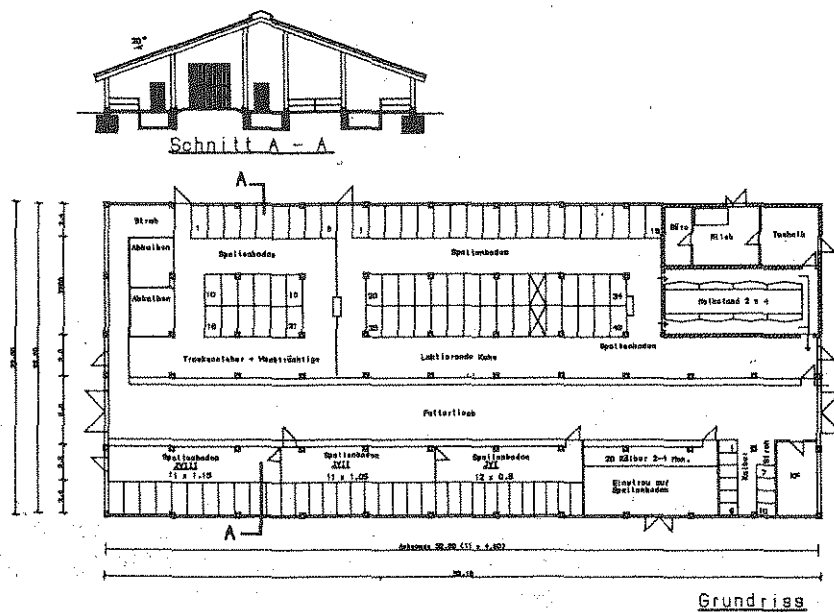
Modellplan für 60 Kühe und Nachzucht (Kaltstall in Rundholzkonstruktion)
